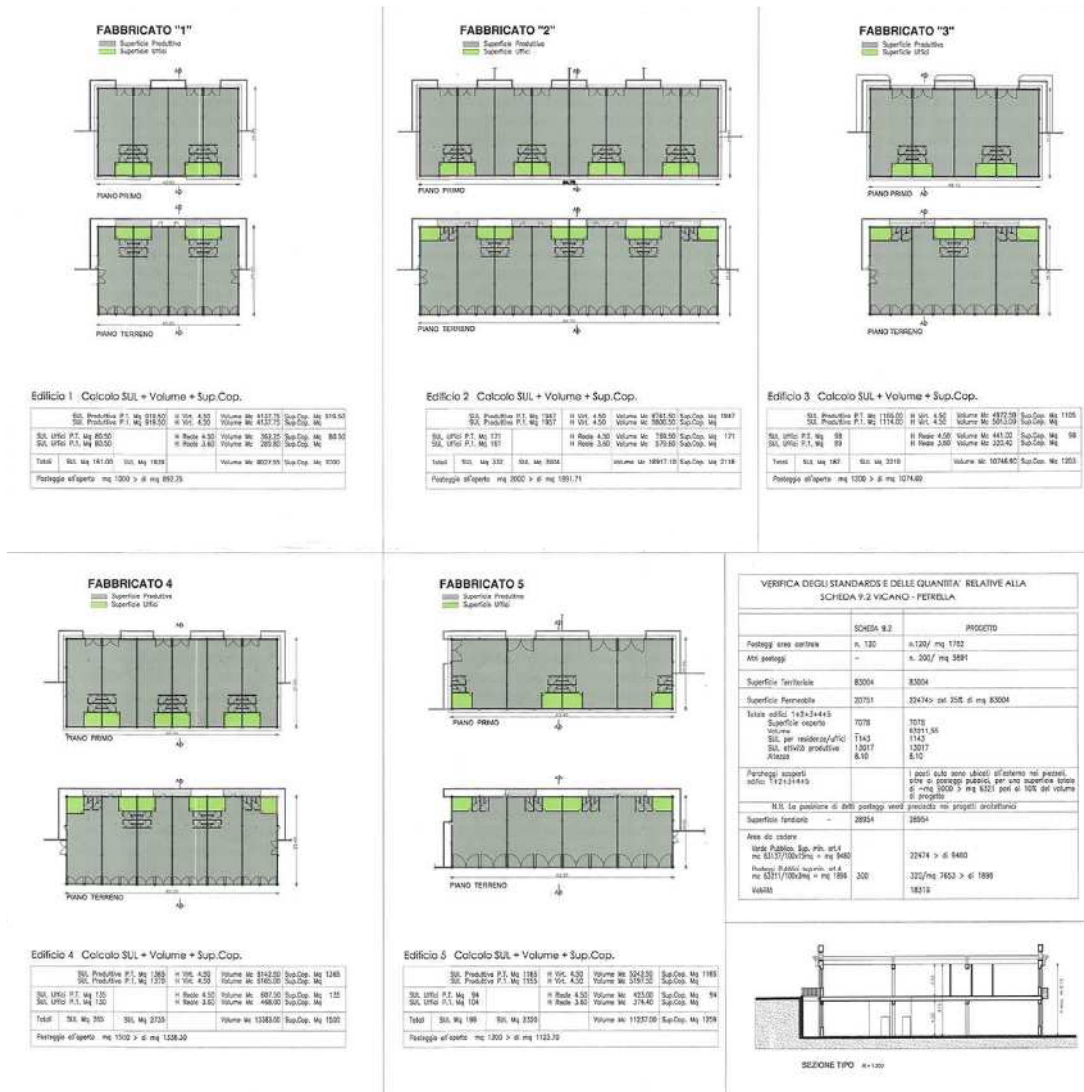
Estratto Tav. n. 16 – stato di progetto: urbanistica . edifici 1+2+3+4+5 – PUC vigente
